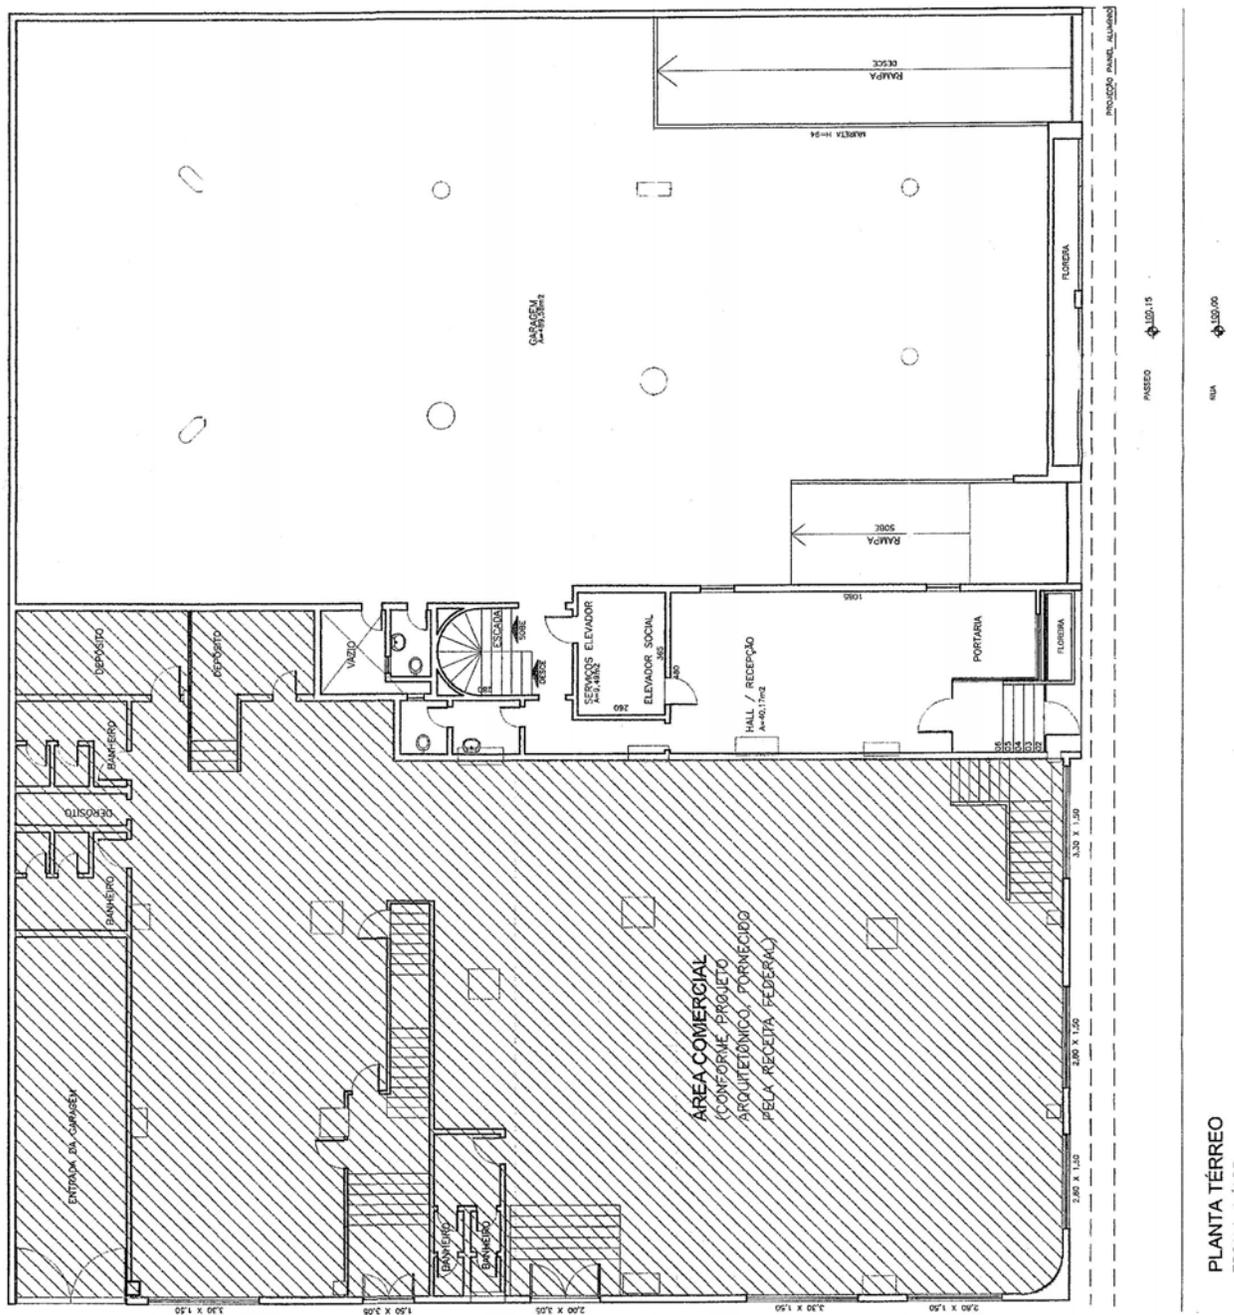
Planta baixa do pavimento térreo (sem escala) do edifício EC 3
